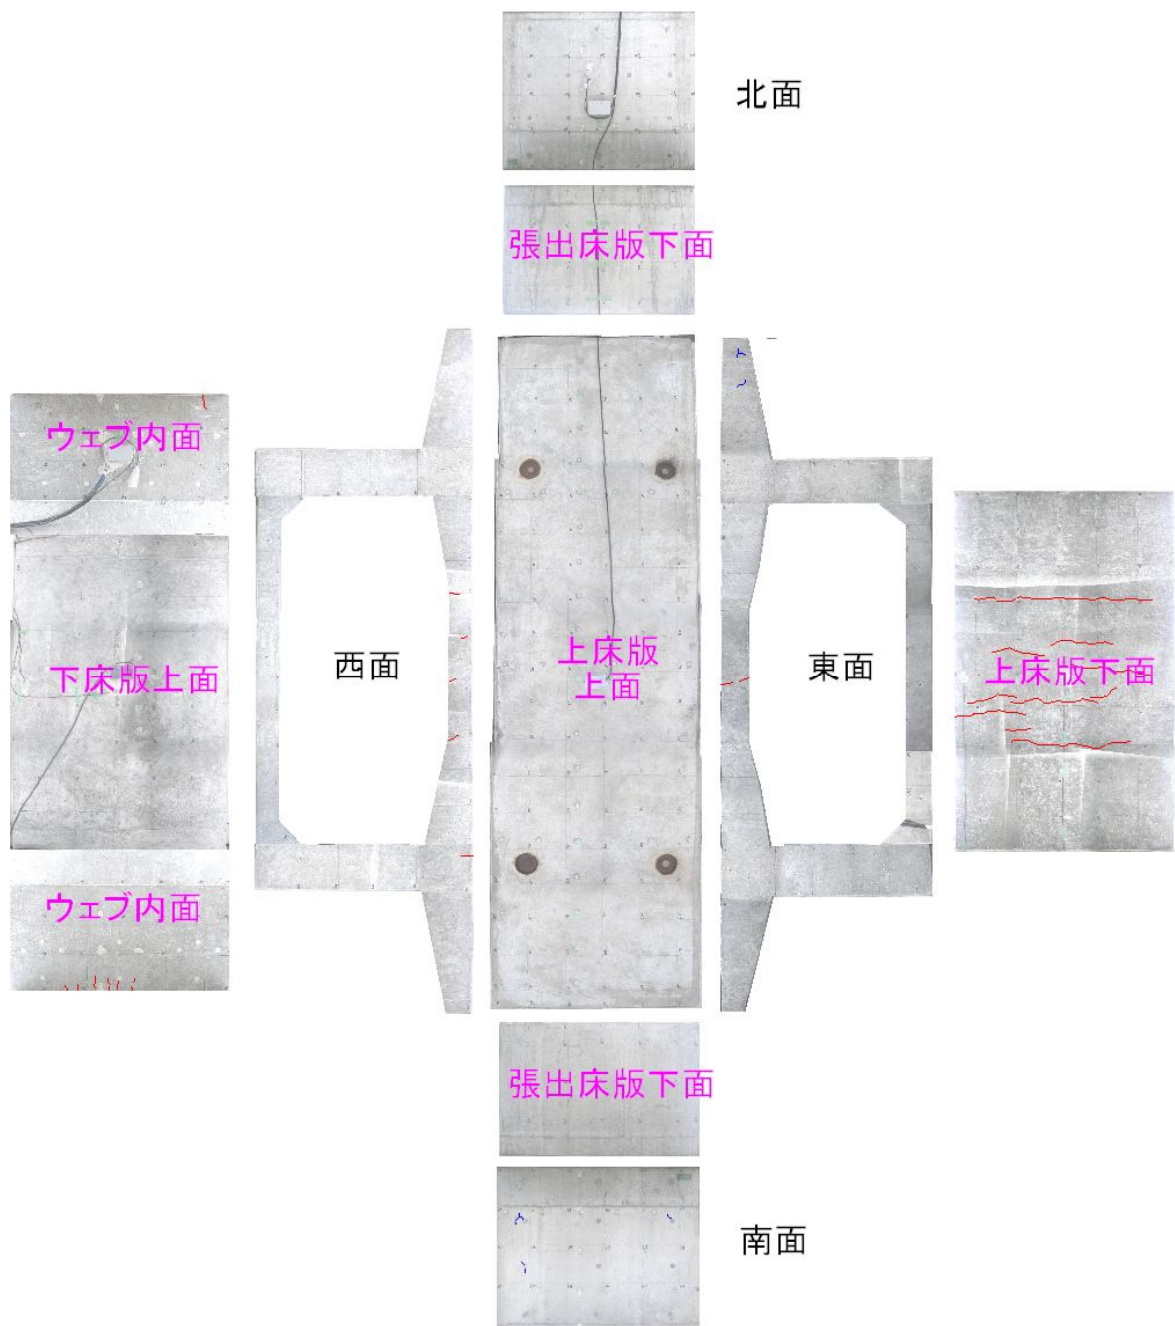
箱桁供試体 L2 ひび割れ状況(2013 年 2 月撮影)
